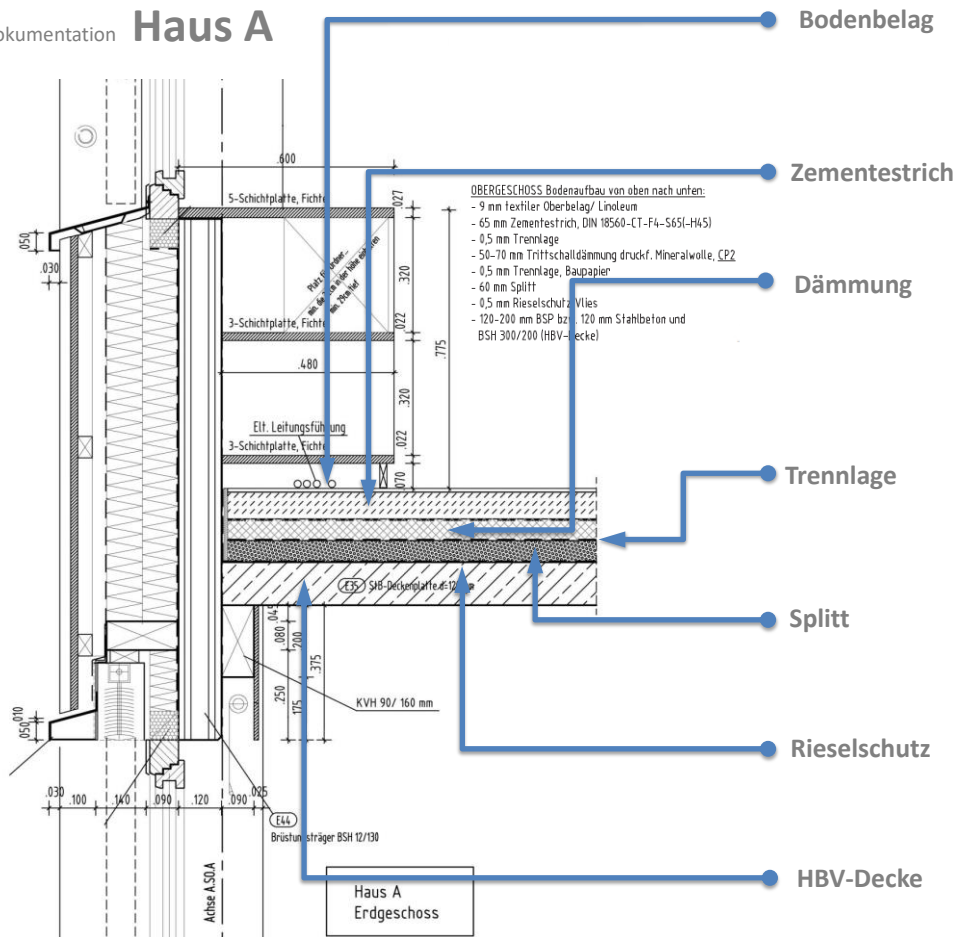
Detail Geschossdecke (HBV) Haus A - Bauteilschichten
